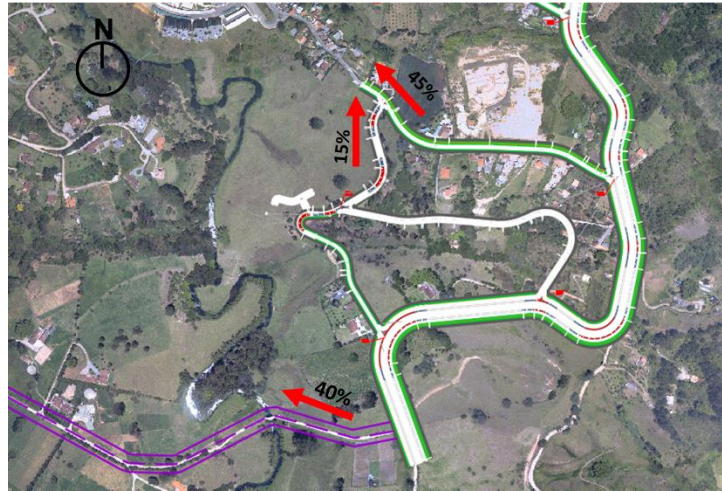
Distribución de los volúmenes del plan parcial Santa Ana Parte Baja
